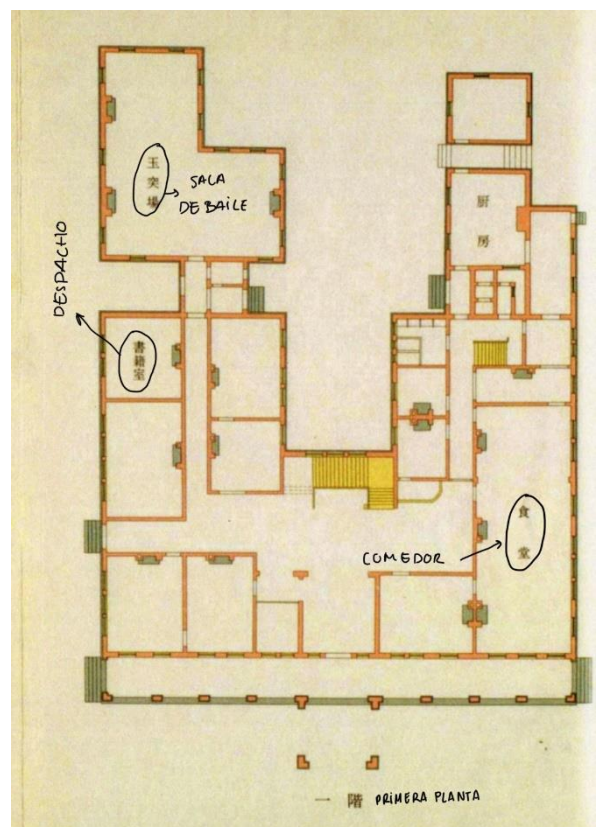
Plano de la primera planta el Rokumeikan. Traducción: elaboración propia. Acceso en: <https://sakamichi.tokyo/?p=17065>
